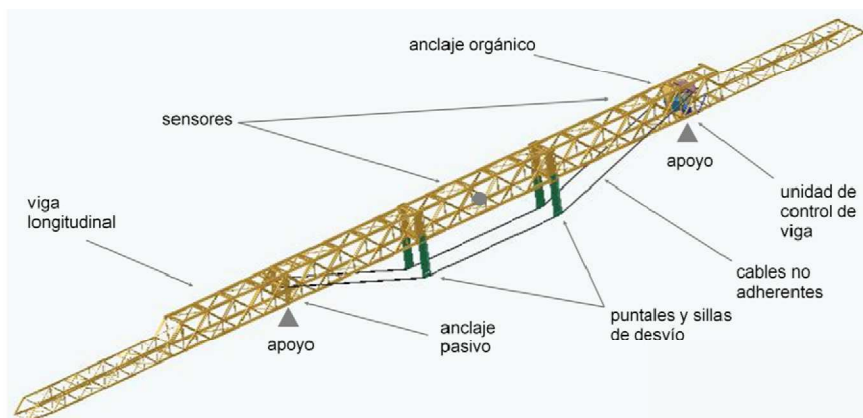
Esquema 3D de viga longitudinal de una autocimbra bajo tablero con OPS [3]
